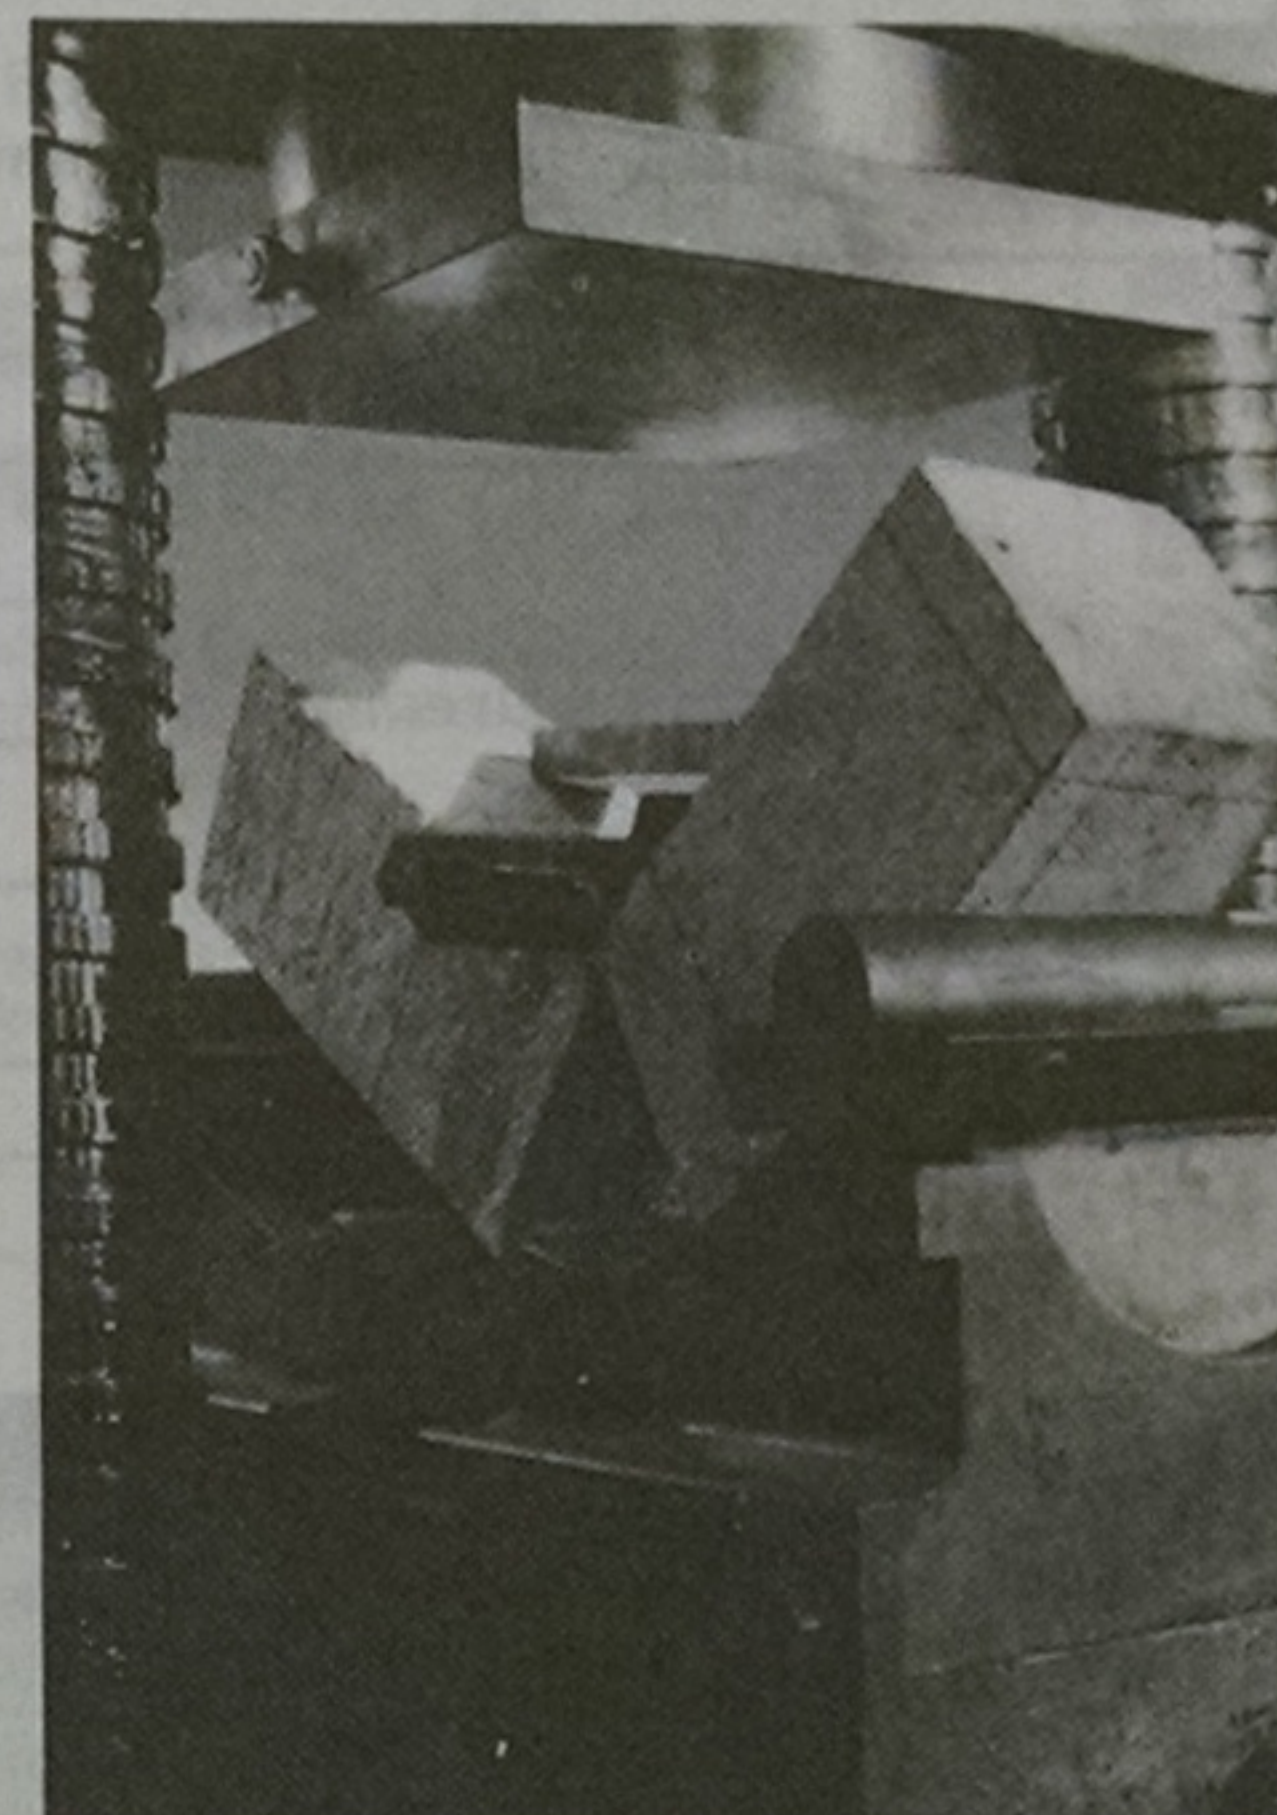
Ruptura típica de viga unida com adesivo epóxi
